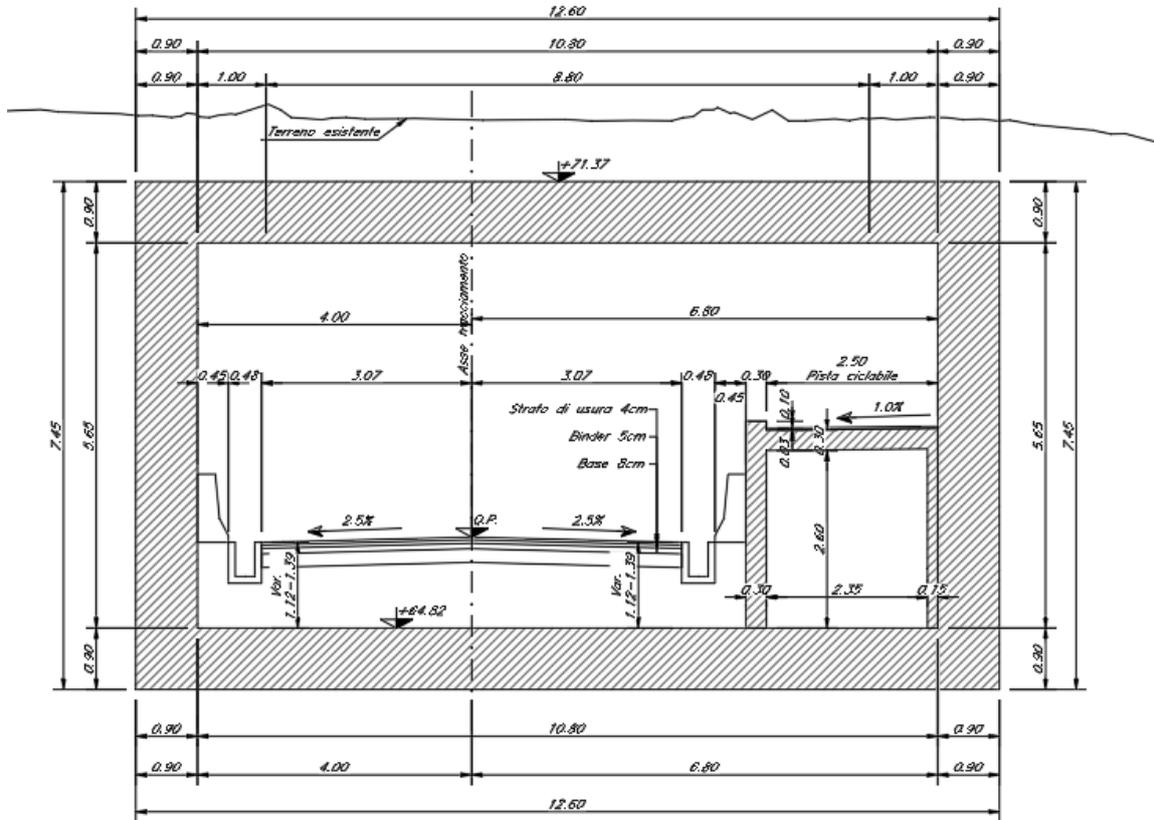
Sottopasso SL01 - Sezione trasversale dello scatolare
